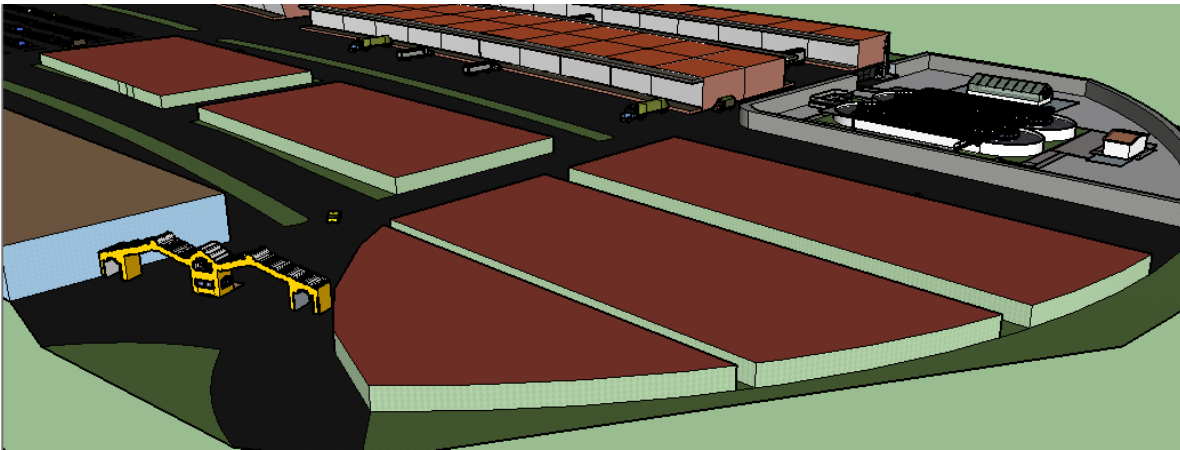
Render en donde se aprecia en primer plano las 5 naves destinadas a la venta de legumbres, cada nave está proyectada a un solo piso con una altura de 4.00 metros.
